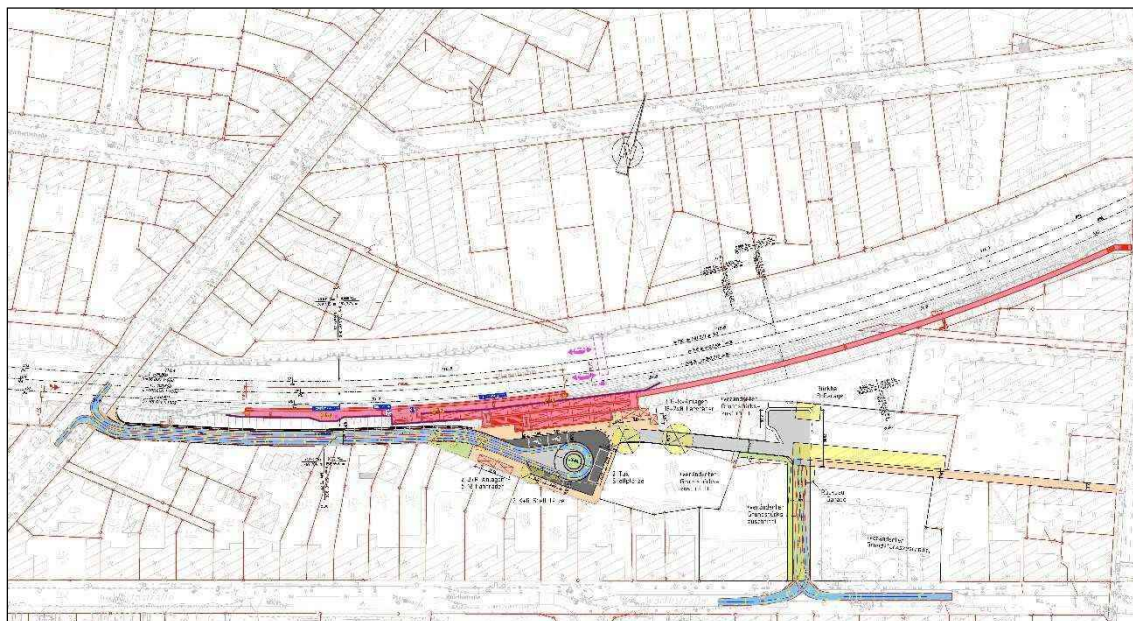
Lageplan mit Darstellung des Konzepts /13/
